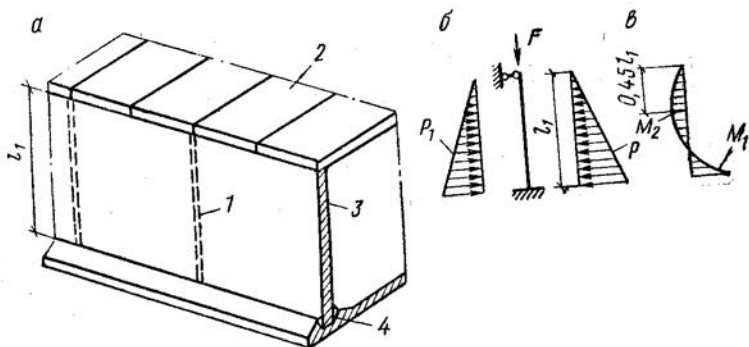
К расчету стены прямоугольного резервуара, работающей по балочной схеме
